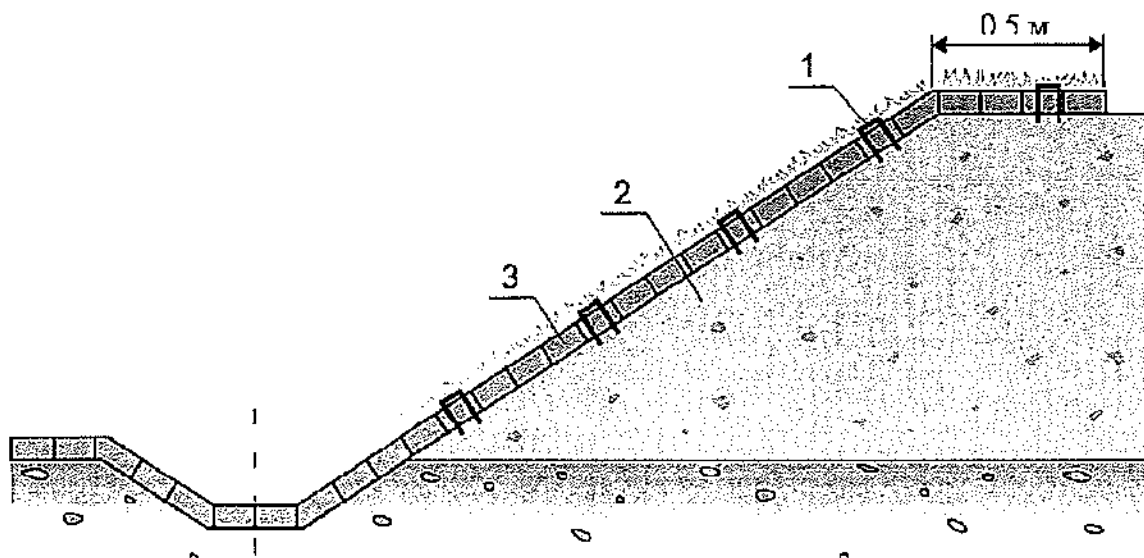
Неподтопляемые откосы (вариант Б): 1-анкера; 2-земляное полотно; 3-заполнитель георешетки (обычно - растительный грунт с посевом семян)
